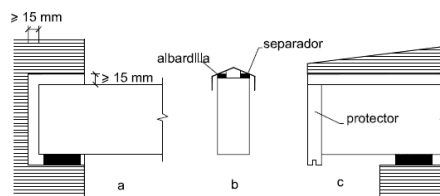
Ejemplos de detalles constructivos de protección de elementos estructurales.
